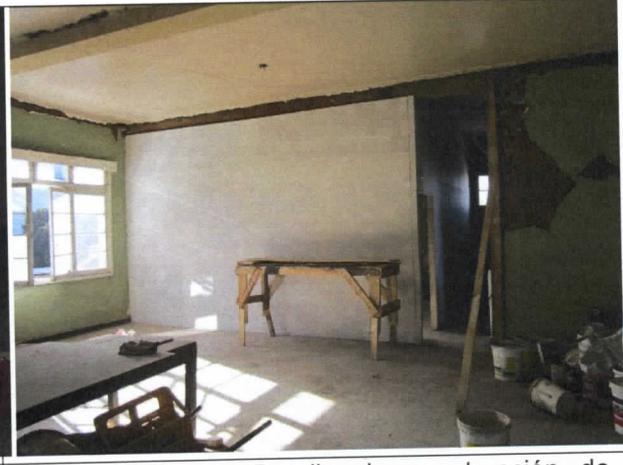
Detalle de trabajos de reparación de cielo de madera, reposición de pilares y tapacanes en pasillo exterior de la edificación. Fecha: 16-06-2015.
